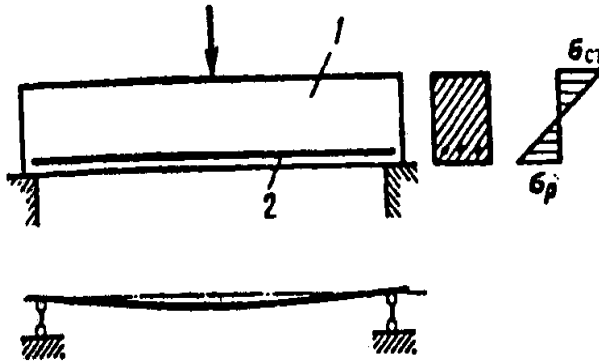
Схема роботи арматури в залізобетонному елементі:
